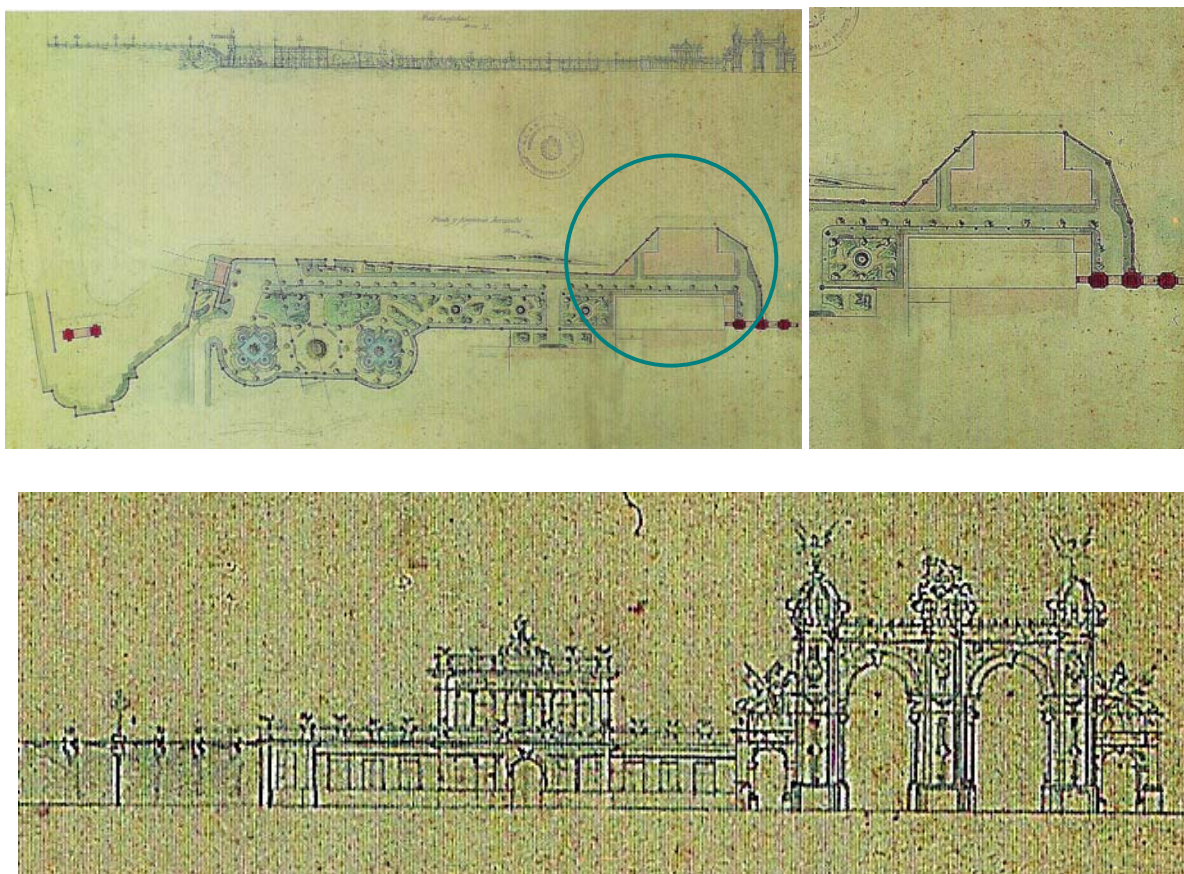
Boulevard Santa Inés. Vista longitudinal, planta, detalle de muro y boceto de la fuente. Plano de conjunto y perfil longitudinal.
